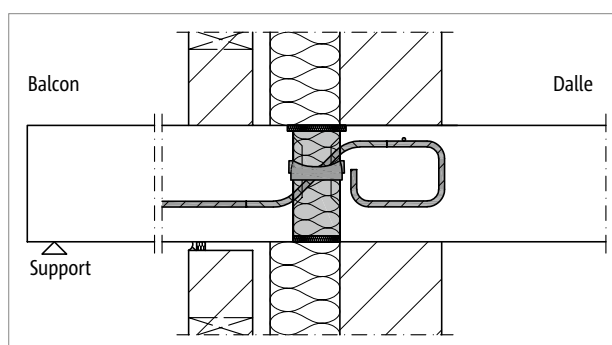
Schöck Isokorb® T Type Q-E-W-V : Raccordement avec isolation du noyau
